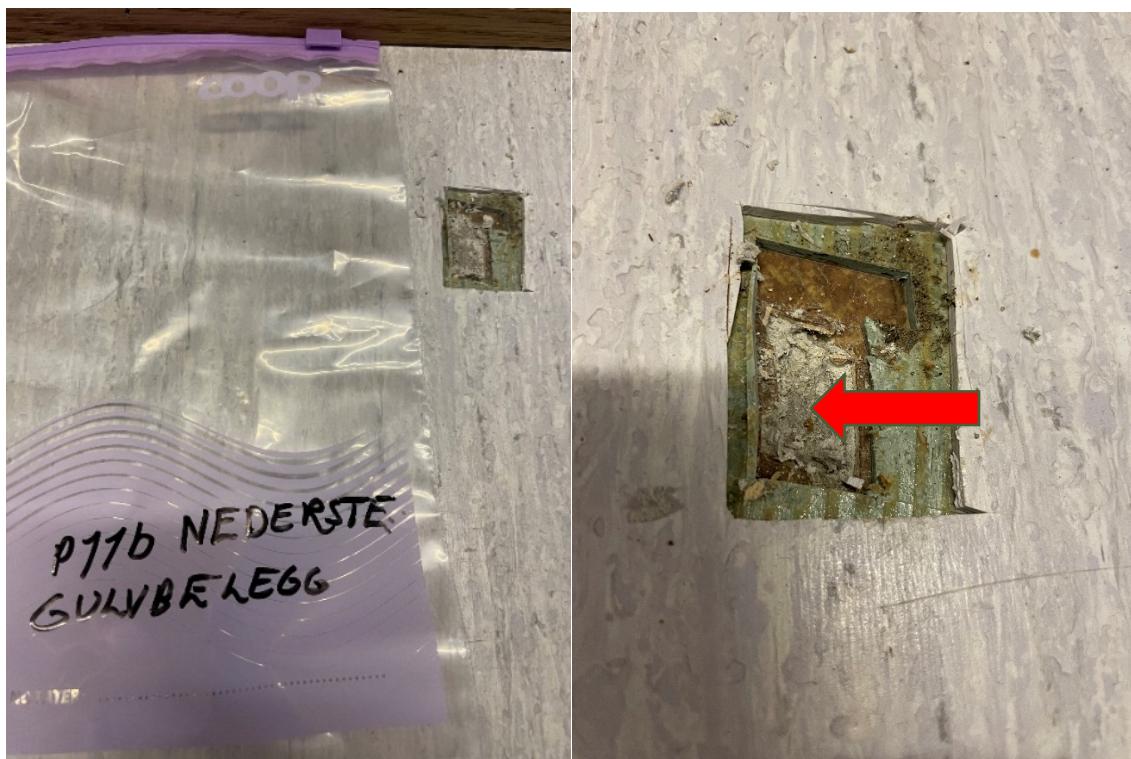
P11 Lysegrønt vinyl gulvbelegg (midterste lag). Plan 1 rom 133 Korridor
